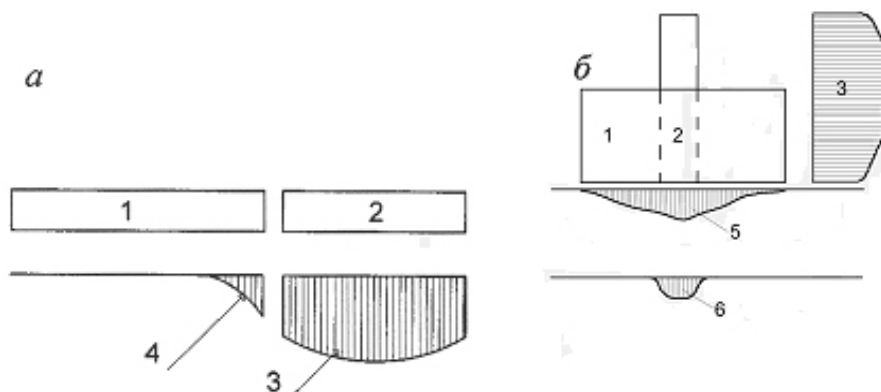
Развитие дополнительных осадок при различном устройстве примыкания зданий: *а* – торцами; *б* – к продольной стене: 1 – существующее здание; 2 – новое здание; 3 – эпюра осадки нового здания; 4 – эпюра дополнительной осадки старого здания; 5 – то же по оси *В*; 6 – то же по оси *А
